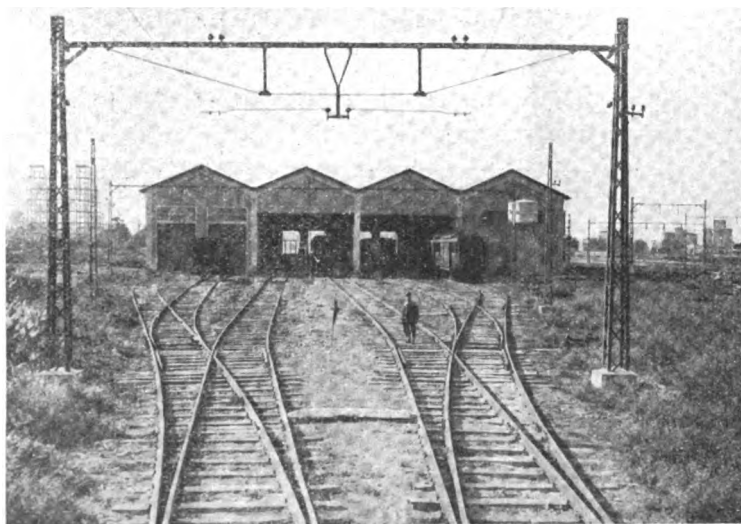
Fabbricato del Deposito a Marina di Ostia.
